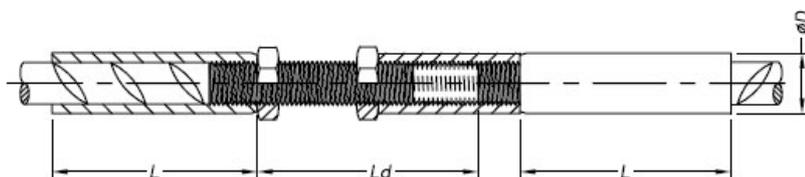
DISTANZÜBERBRÜCKENDE POSITIONSVERBINDUNG (PII) (Alternativ)
